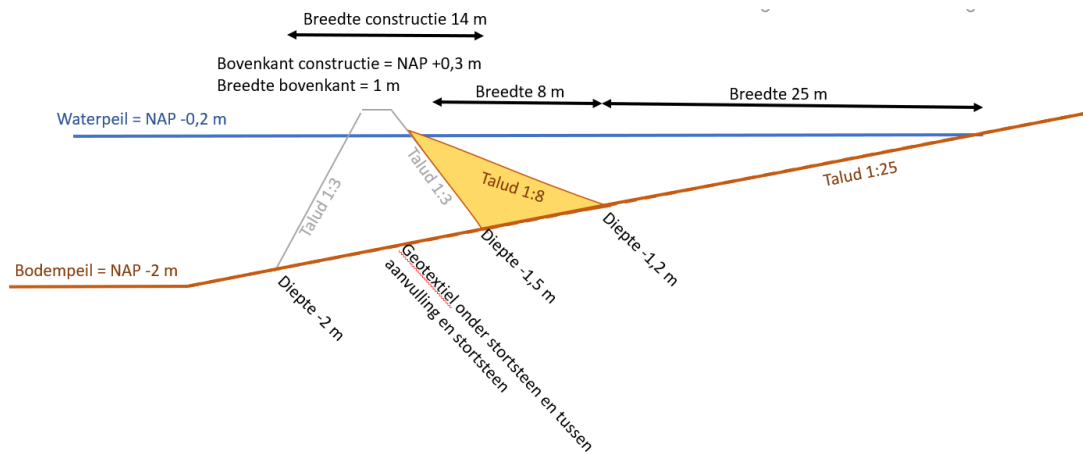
Doorsnede 'het water in': Houten Damwand
